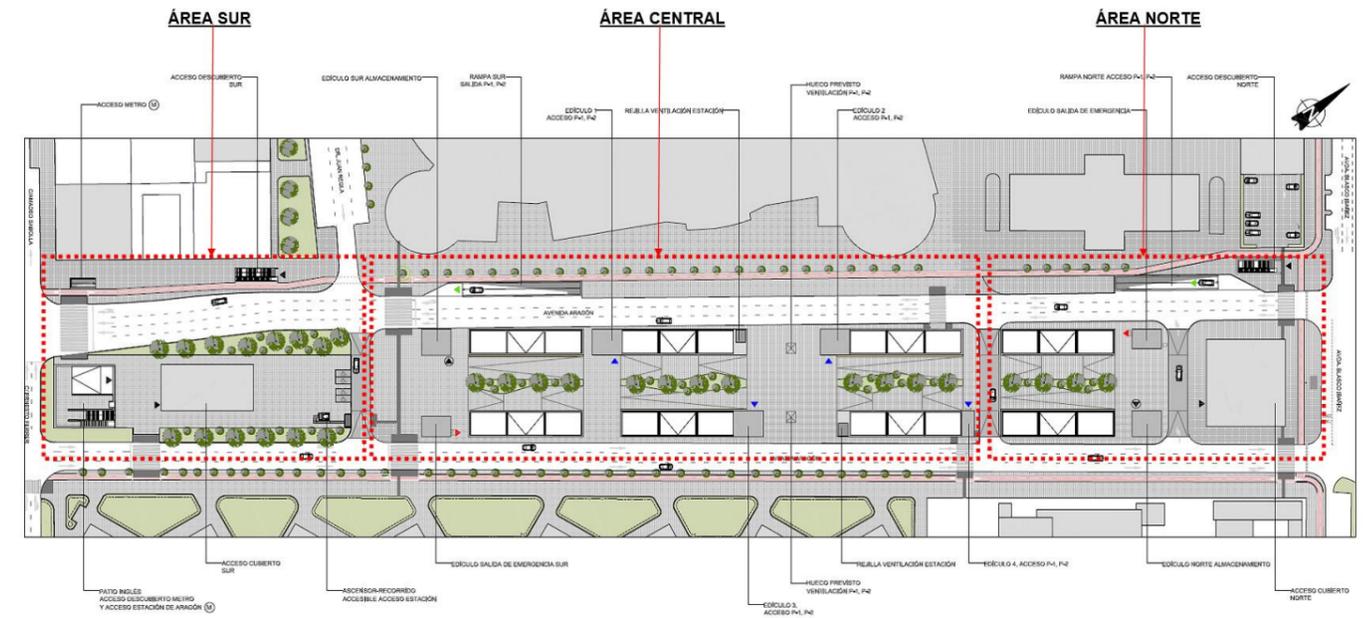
Planta general. Estación subterránea de Aragón (zona sobre rasante)
